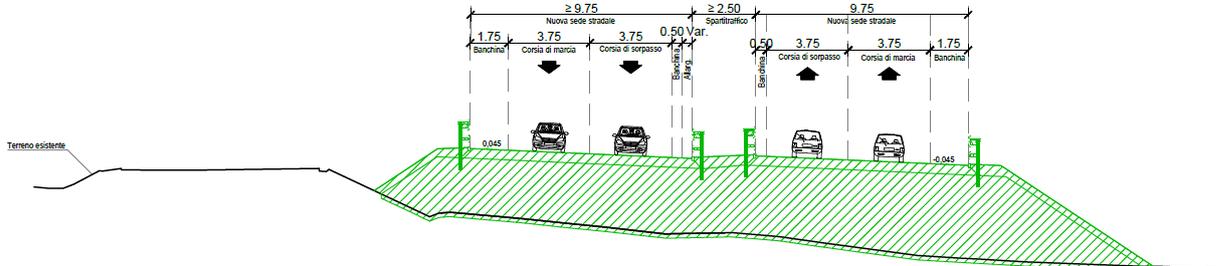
Sezioni tipologiche fasi di cantiere –rilevato completamente in variante - rif. elaborato D01-T100-CA017-1-W9-001-0A
